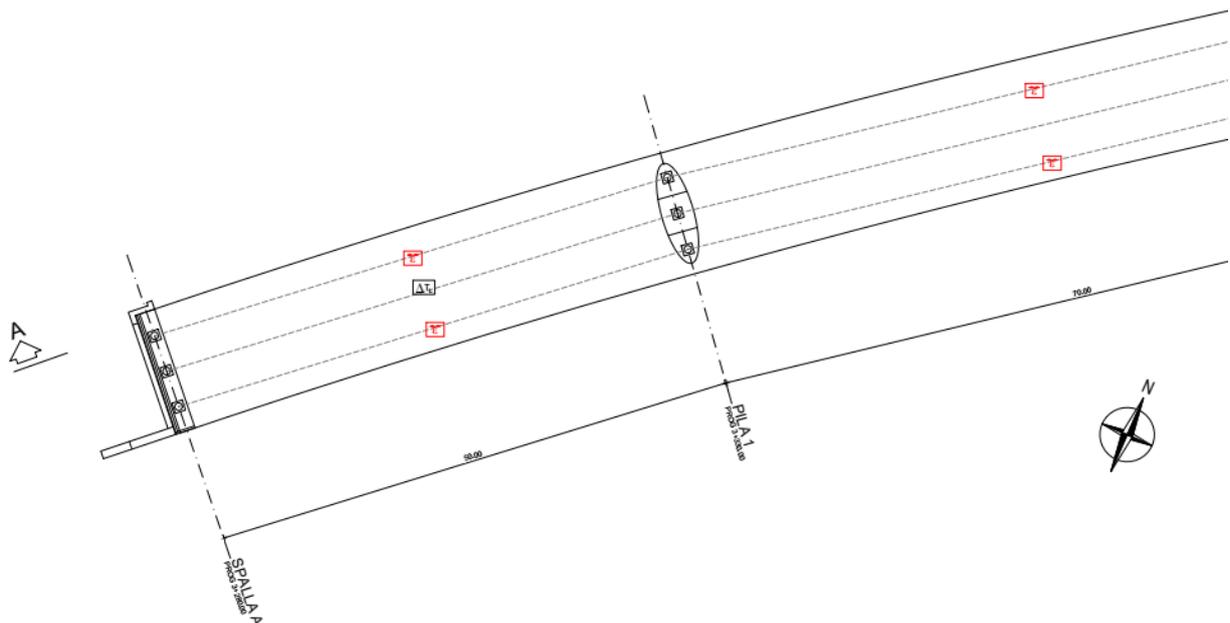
Ubicazione sensori su impalcato sezione a 3 travi (Pianta viadotto Tevere)
